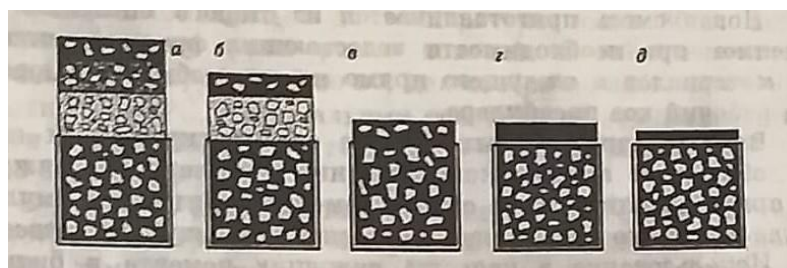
Возможные конструкции дорожной одежды со слоем ресайклинга в основании: а - укладка сверху дополнительного слоя основания, биндера и покрытия; б - укладка сверху биндера и покрытия; в - укладка сверху покрытия; г - укладка сверху тонкослойного асфальтобетона; д - устройство сверху поверхностной обработки.
